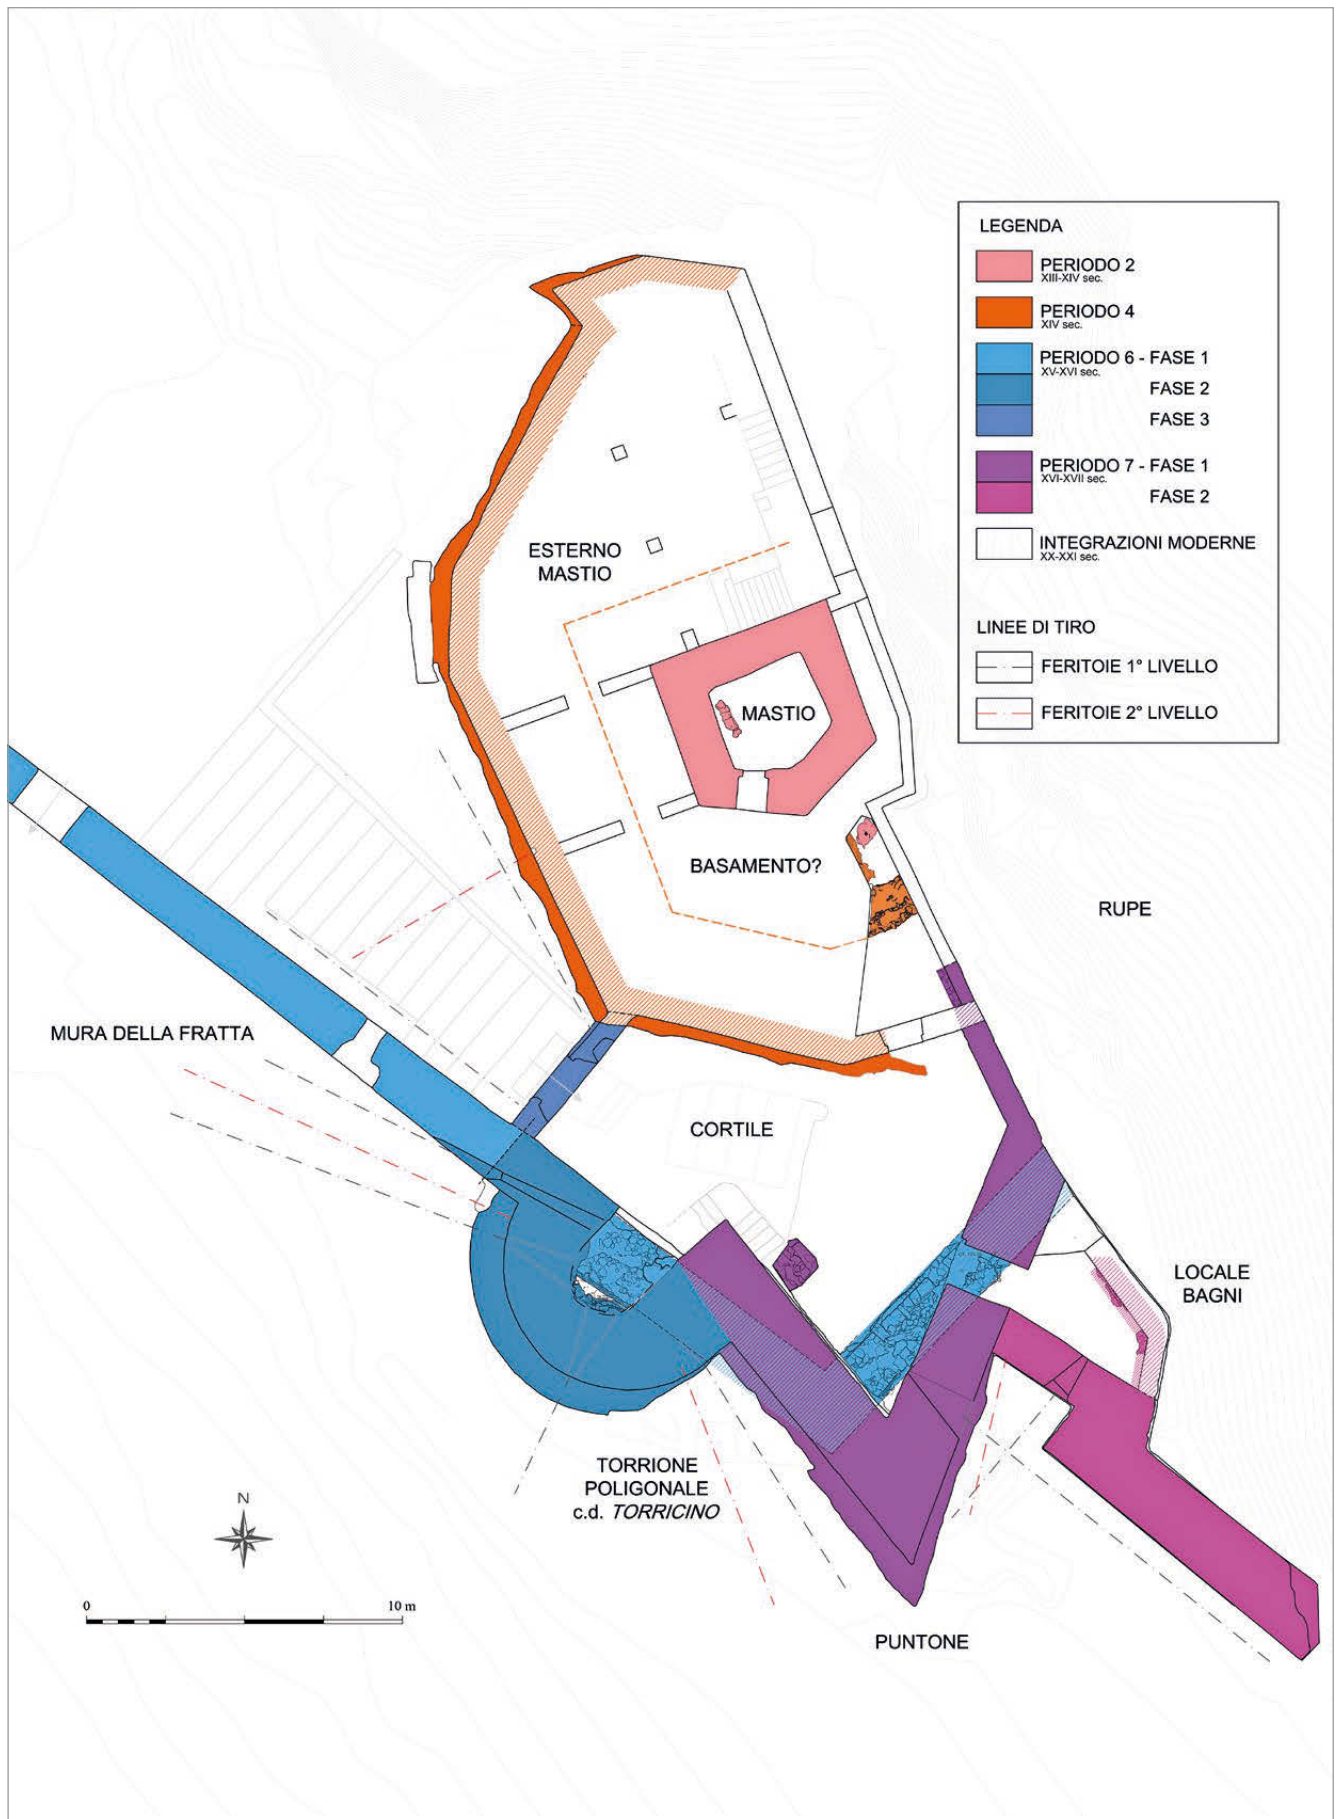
Pianta di fase del complesso della Seconda Torre.
